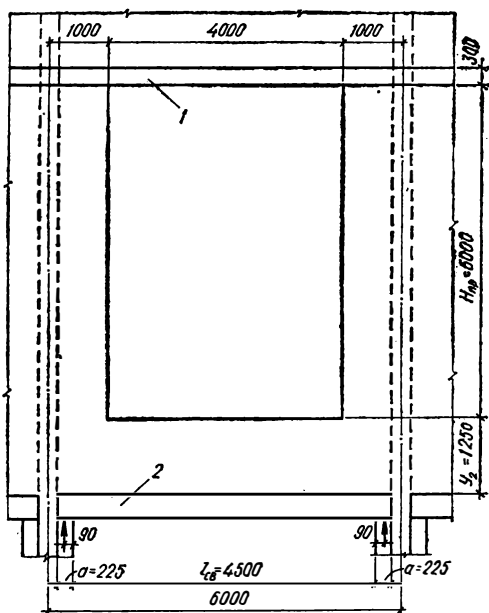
Схема стены и фундаментной балки: 1 — железобетонная обвязочная балка, 2 — фундаментная балка.
